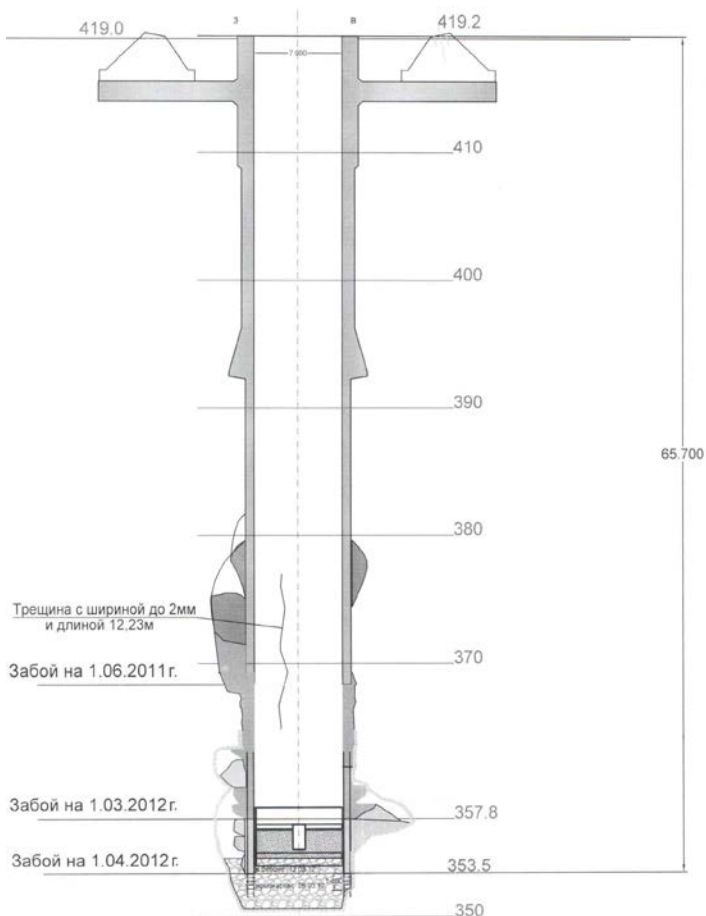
Вертикальное сечение ствола «Южный Вентиляционный» с местами произошедших вывалов закрепного пространства и трещинообразований в железобетонной крепи
